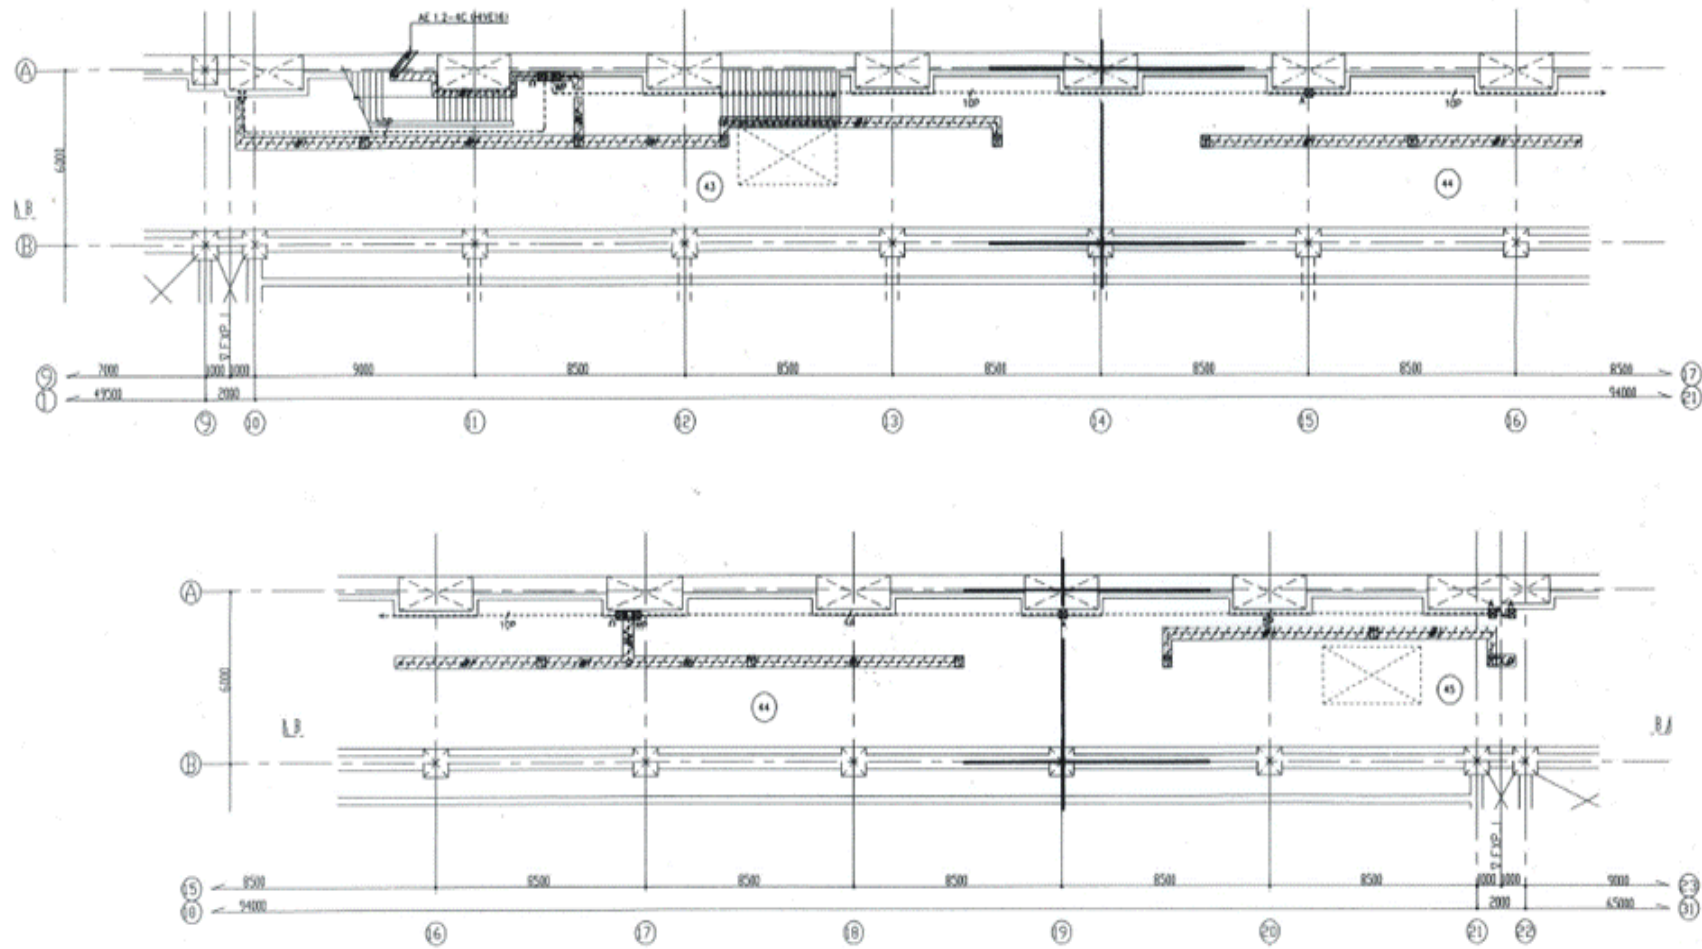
系水処理棟（反応タンク） 地下2階平面図（既設）
